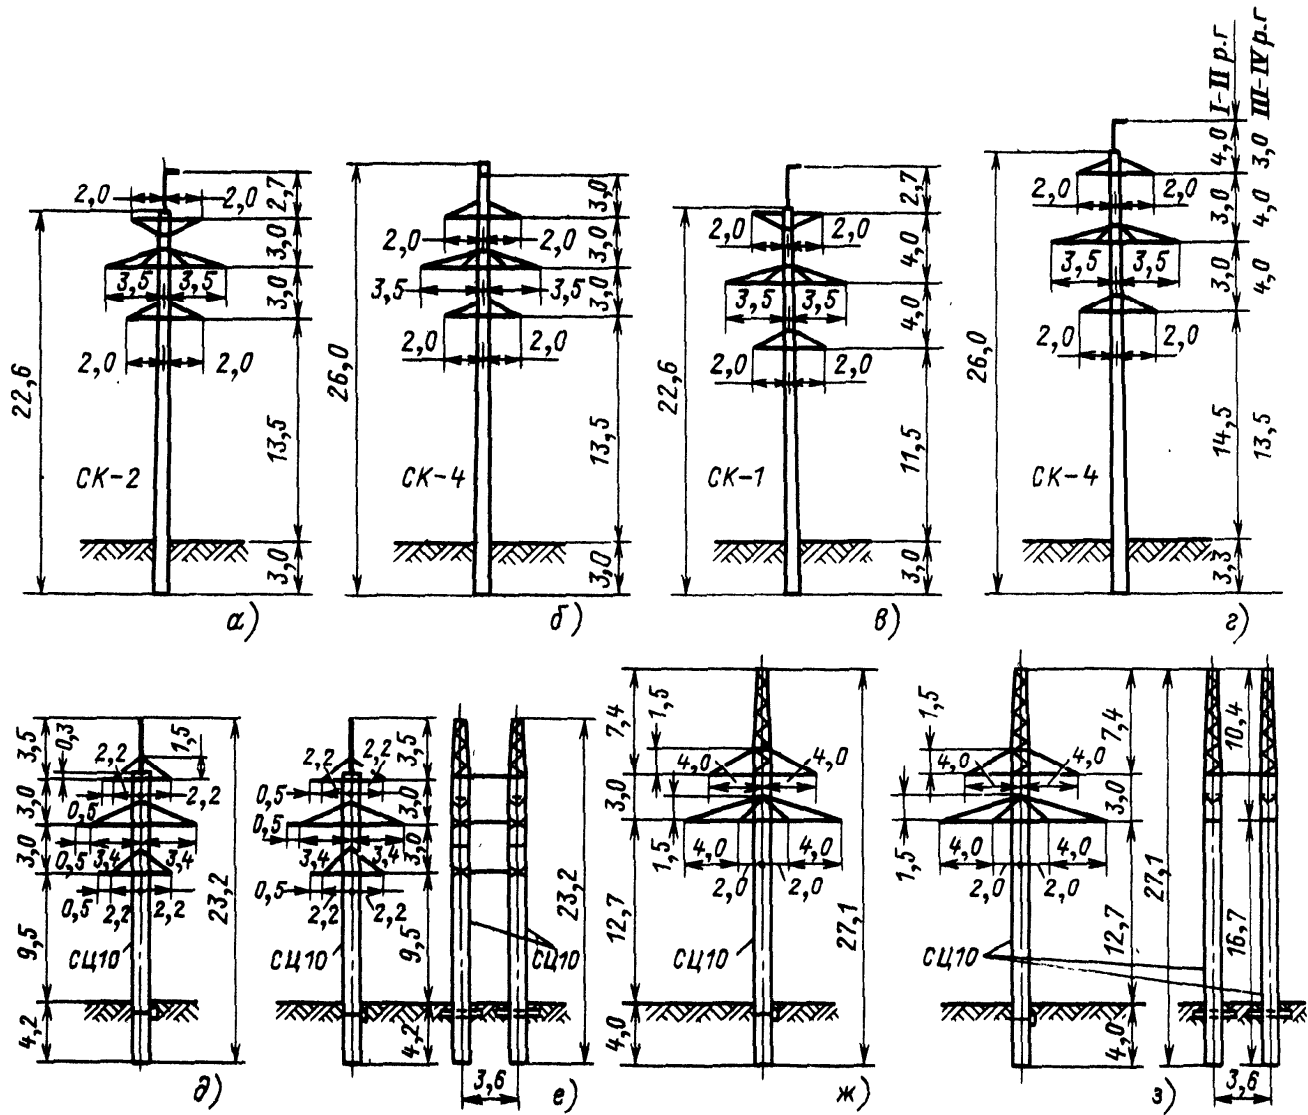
Унифицированные и типовые двухцепные железобетонные опоры 110 кВ
